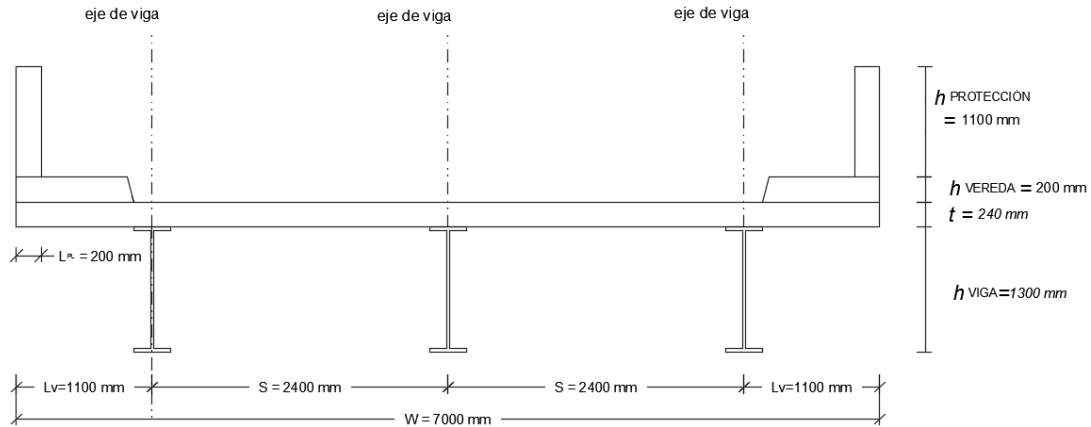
Sección transversal de la superestructura del puente. Realizado por: Autor
